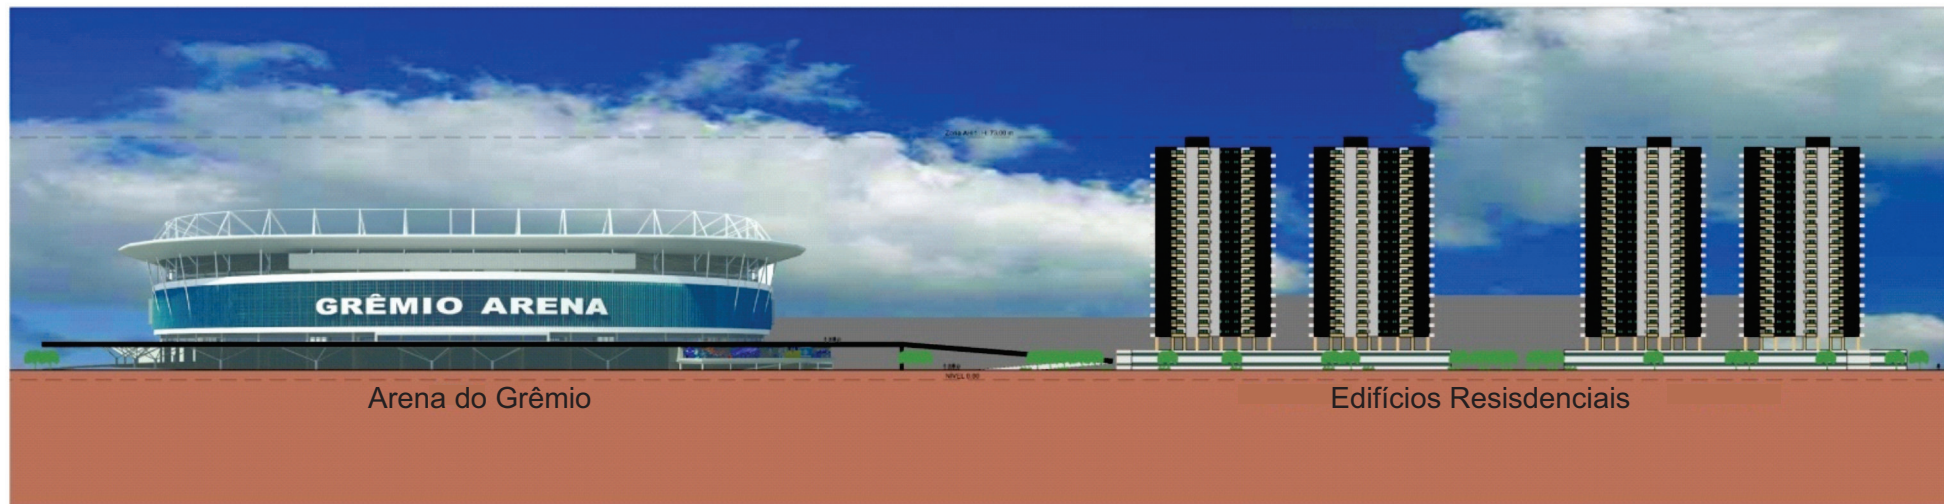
Fachada Av. Padre Leopoldo Bretano
